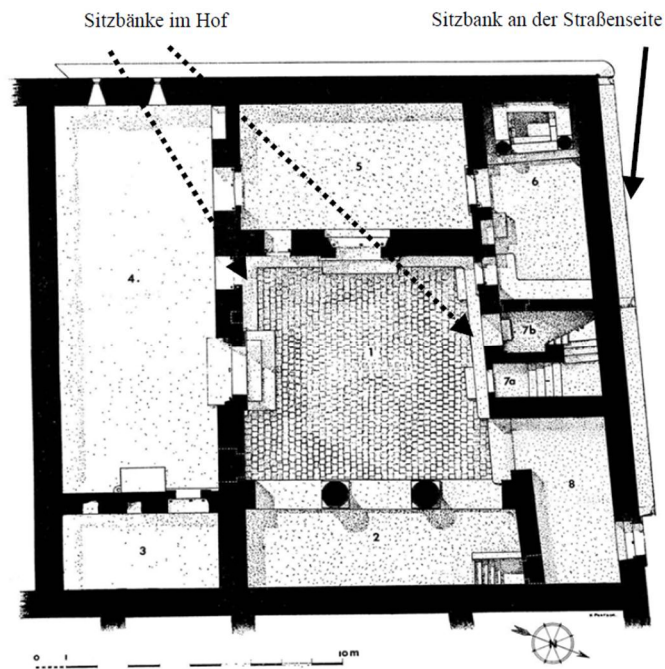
Grundriss Hauskirche Dura Europos, um 240-256 n. Chr., Syrien.
